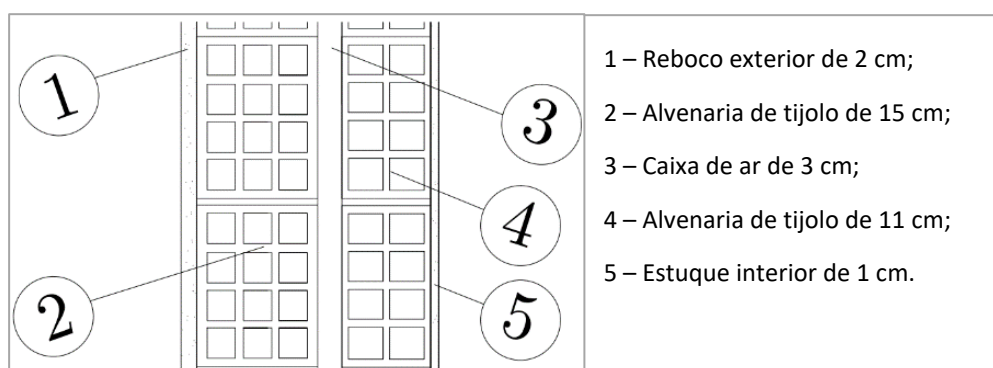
Constituição das paredes exteriores da parte ampliada.
